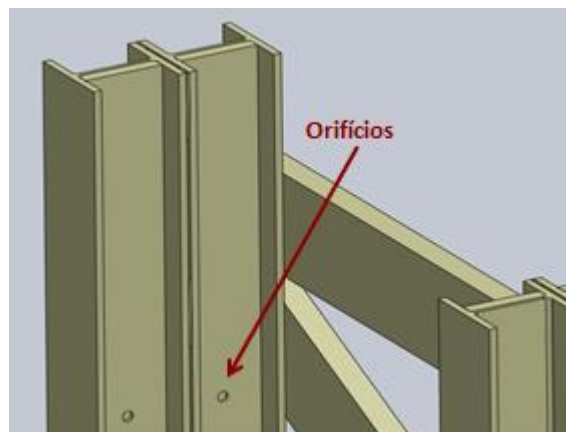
Vista em detalhe da coluna com o reforço da placa e os orifícios para soldadura.
